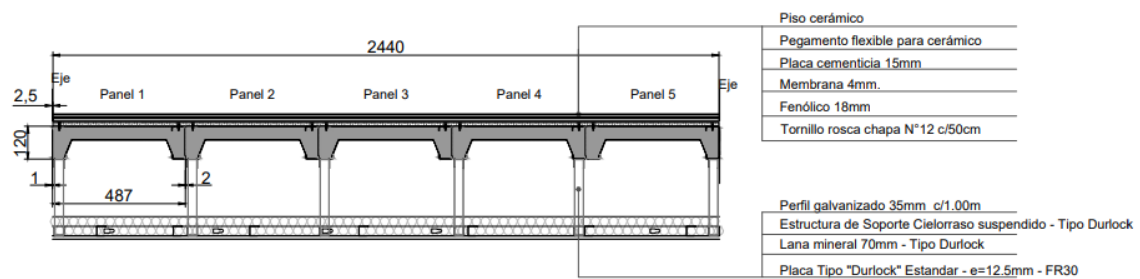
Detalle constructivo paneles de entepiso. Fuente: (<http://entrepisos.ltnargentina.com/wp-content/uploads/2019/03/plano-3.pdf>)
